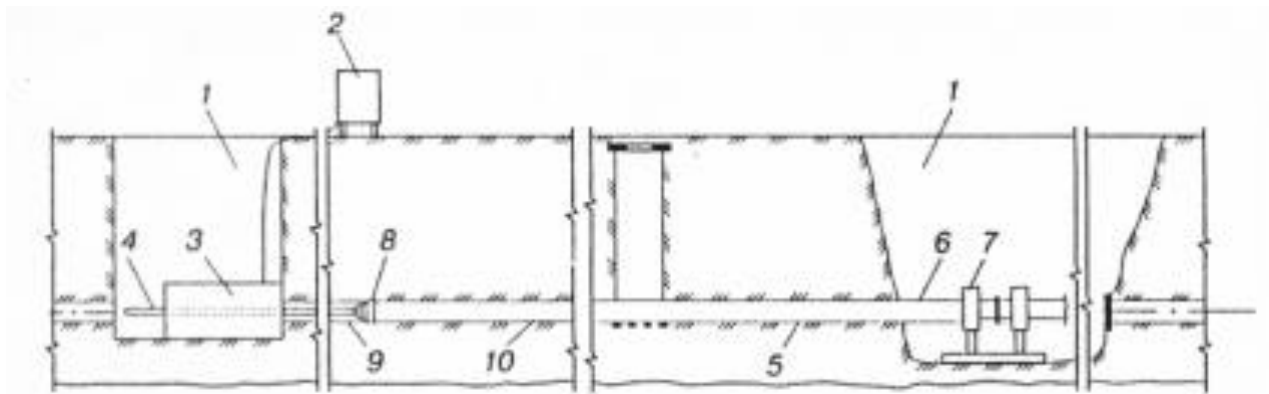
Протаскивание нового трубопровода без разрушения старого
